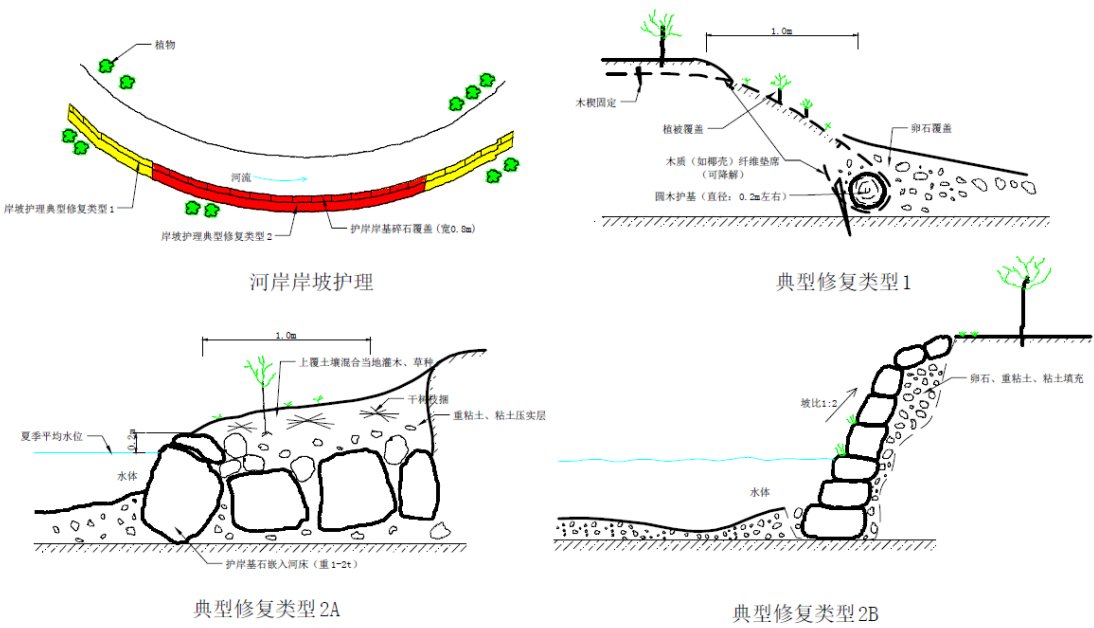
岸坡护理典型修复平面、剖面图
